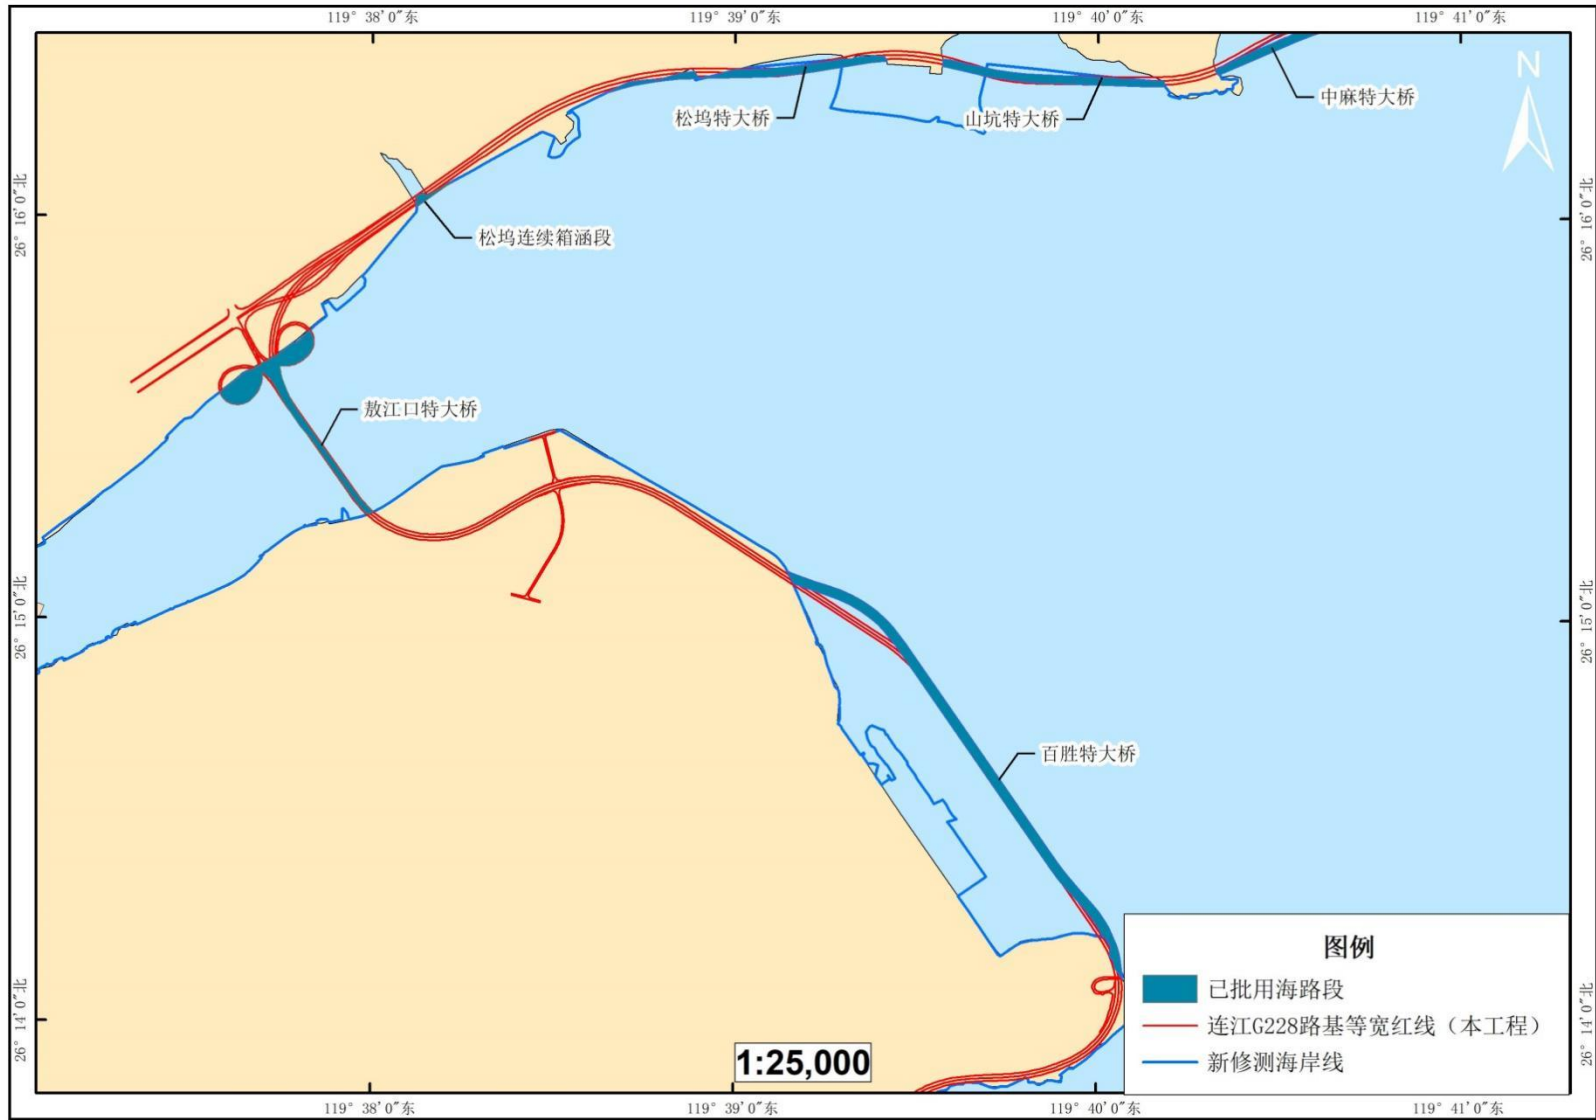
本工程涉海路段平面布置图 (分幅 2)
